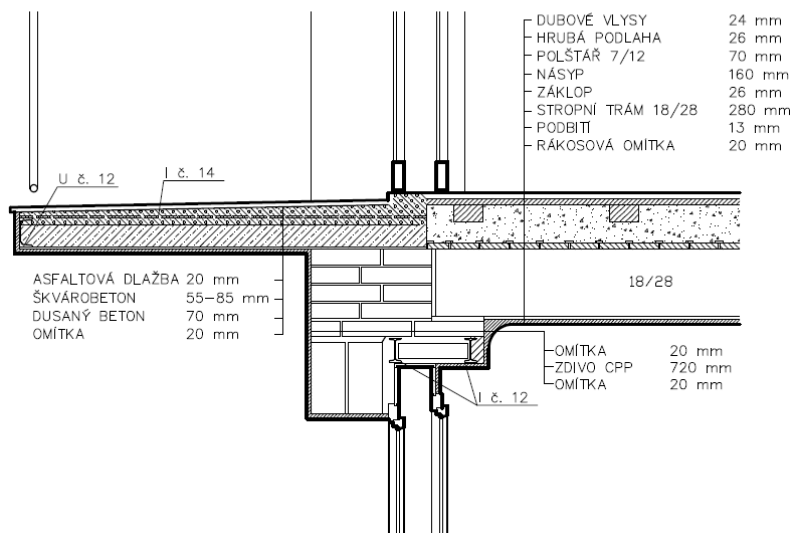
Detail arkýře nad vjezdem- Původní stav
